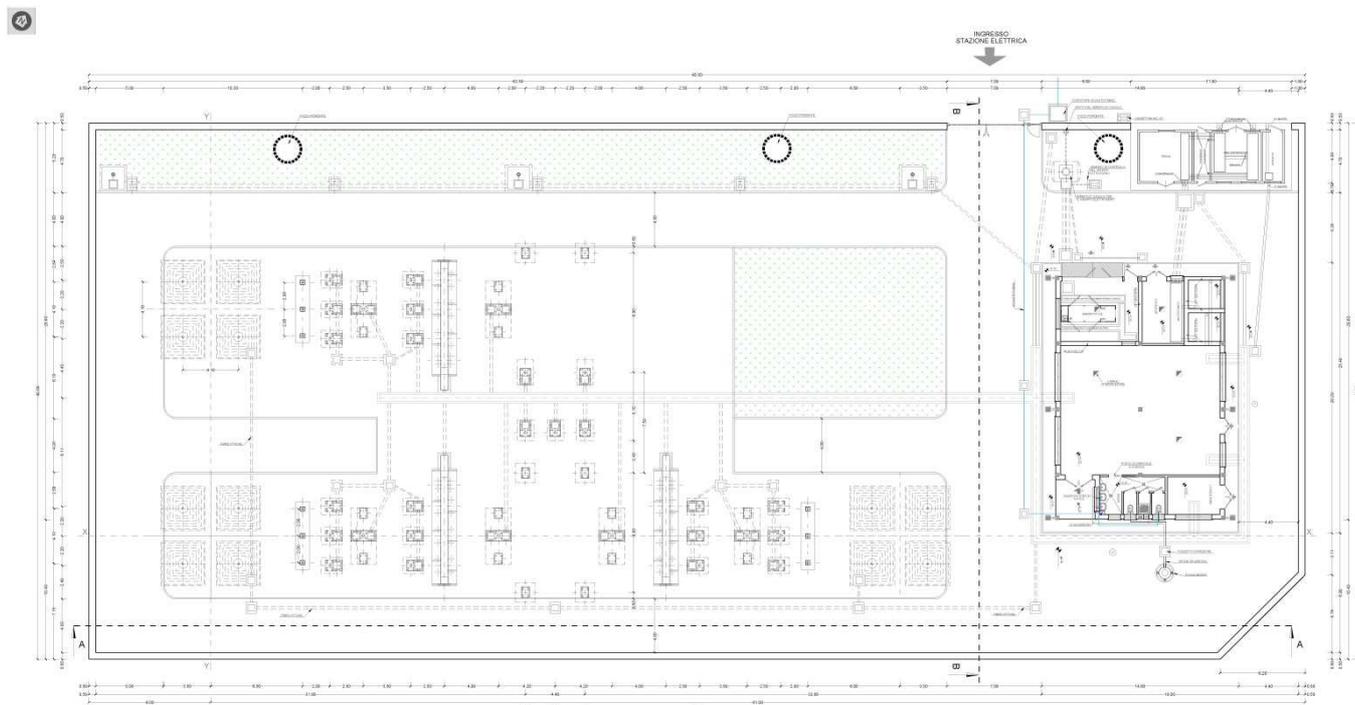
Planimetria nuova stazione elettrica di Leseugno
